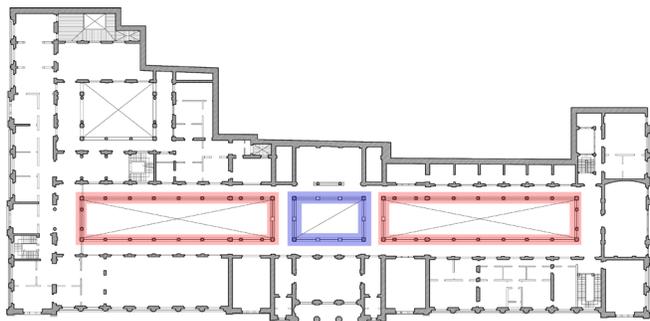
Planta nivel 3 Palacio de Tribunales. Pilares que reciben empujes laterales. Elaboración propia
